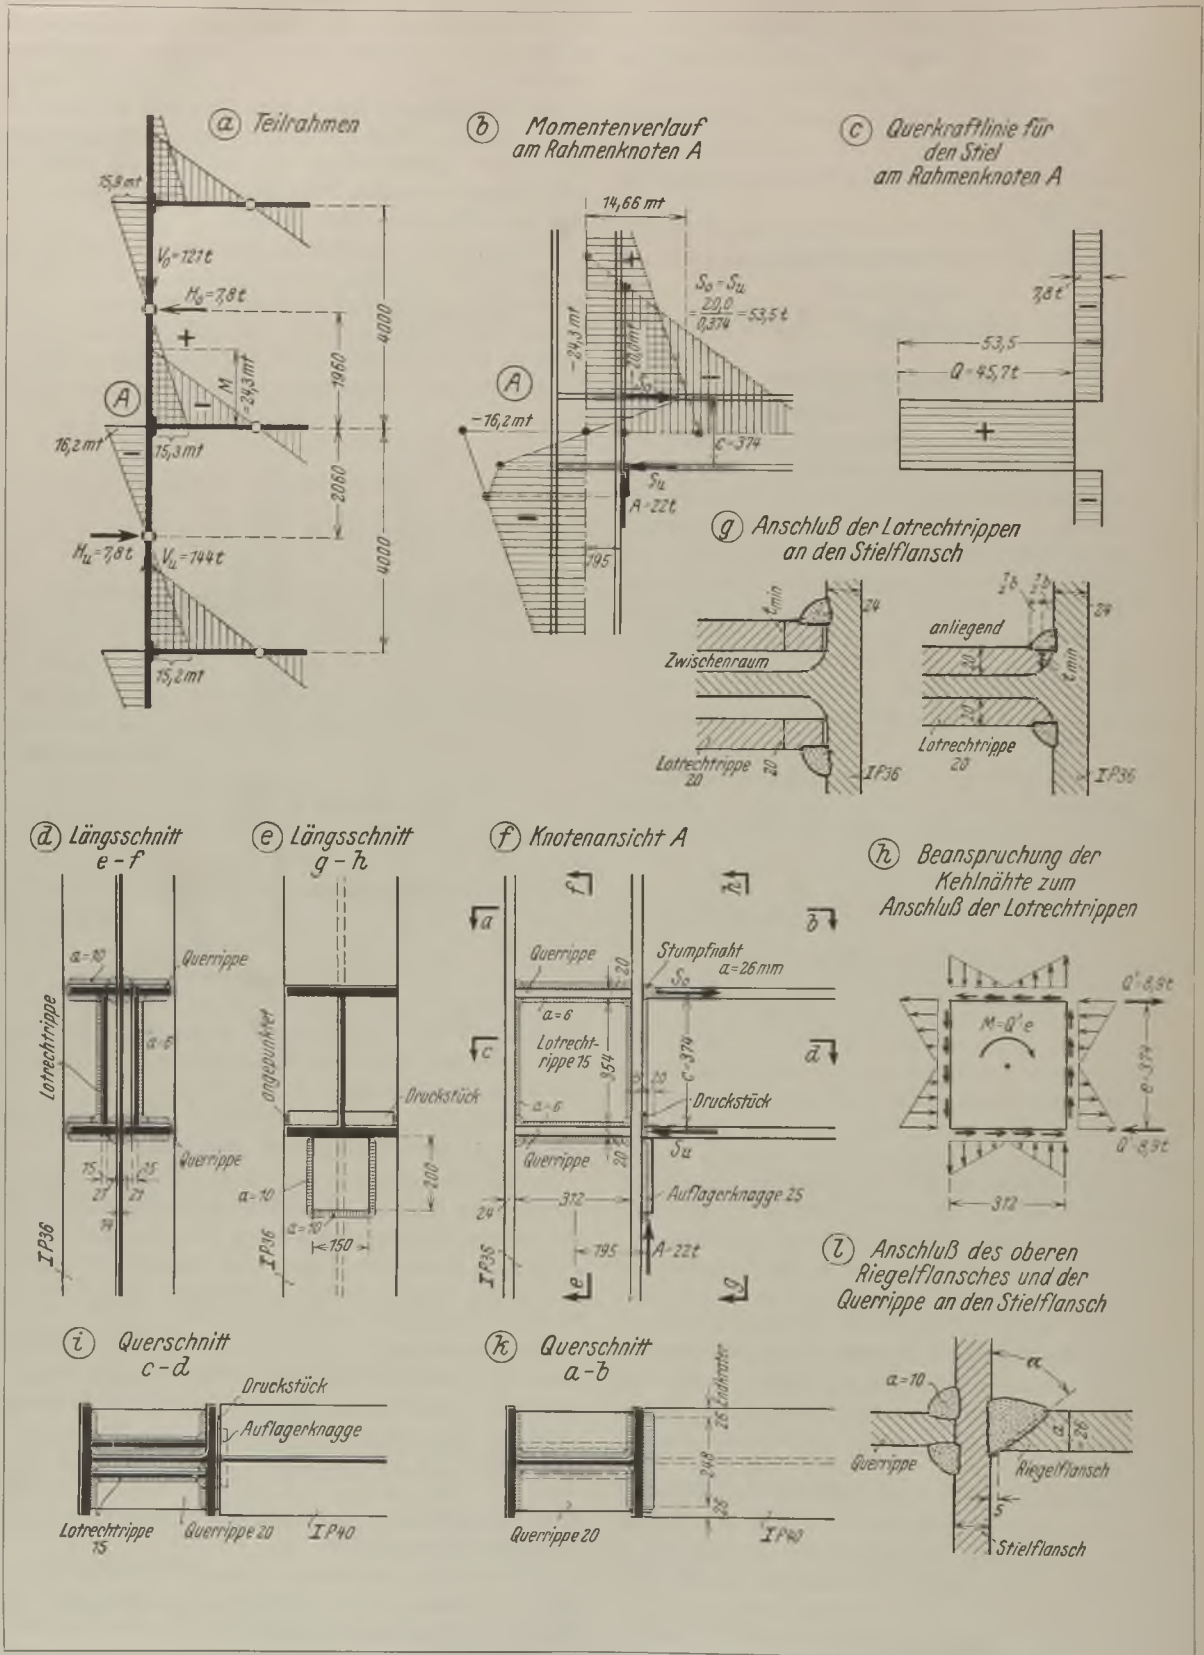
Rahmenknoten mit Baustellenschweißung.
